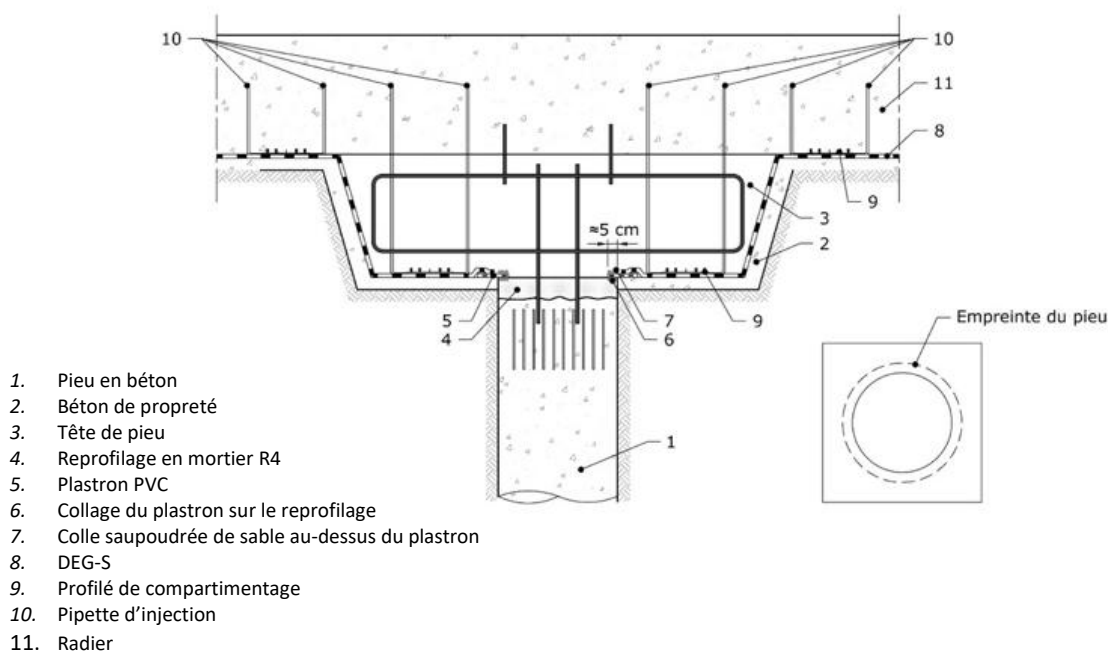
Exemple de raccordement d'un DEG-S sur un pieu muni d'une tête
